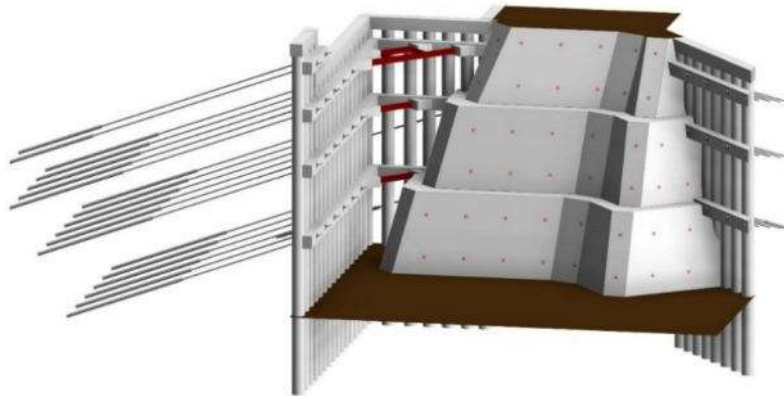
Emboque PK-Noroeste – Corte Tipo
